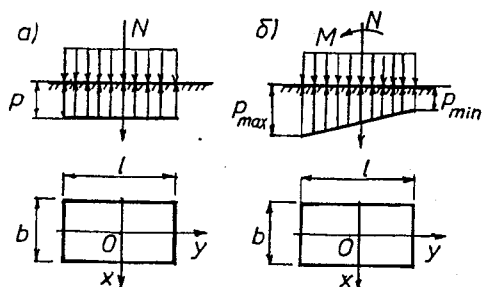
Эпюры давлений под подошвой прямоугольного фундамента:
